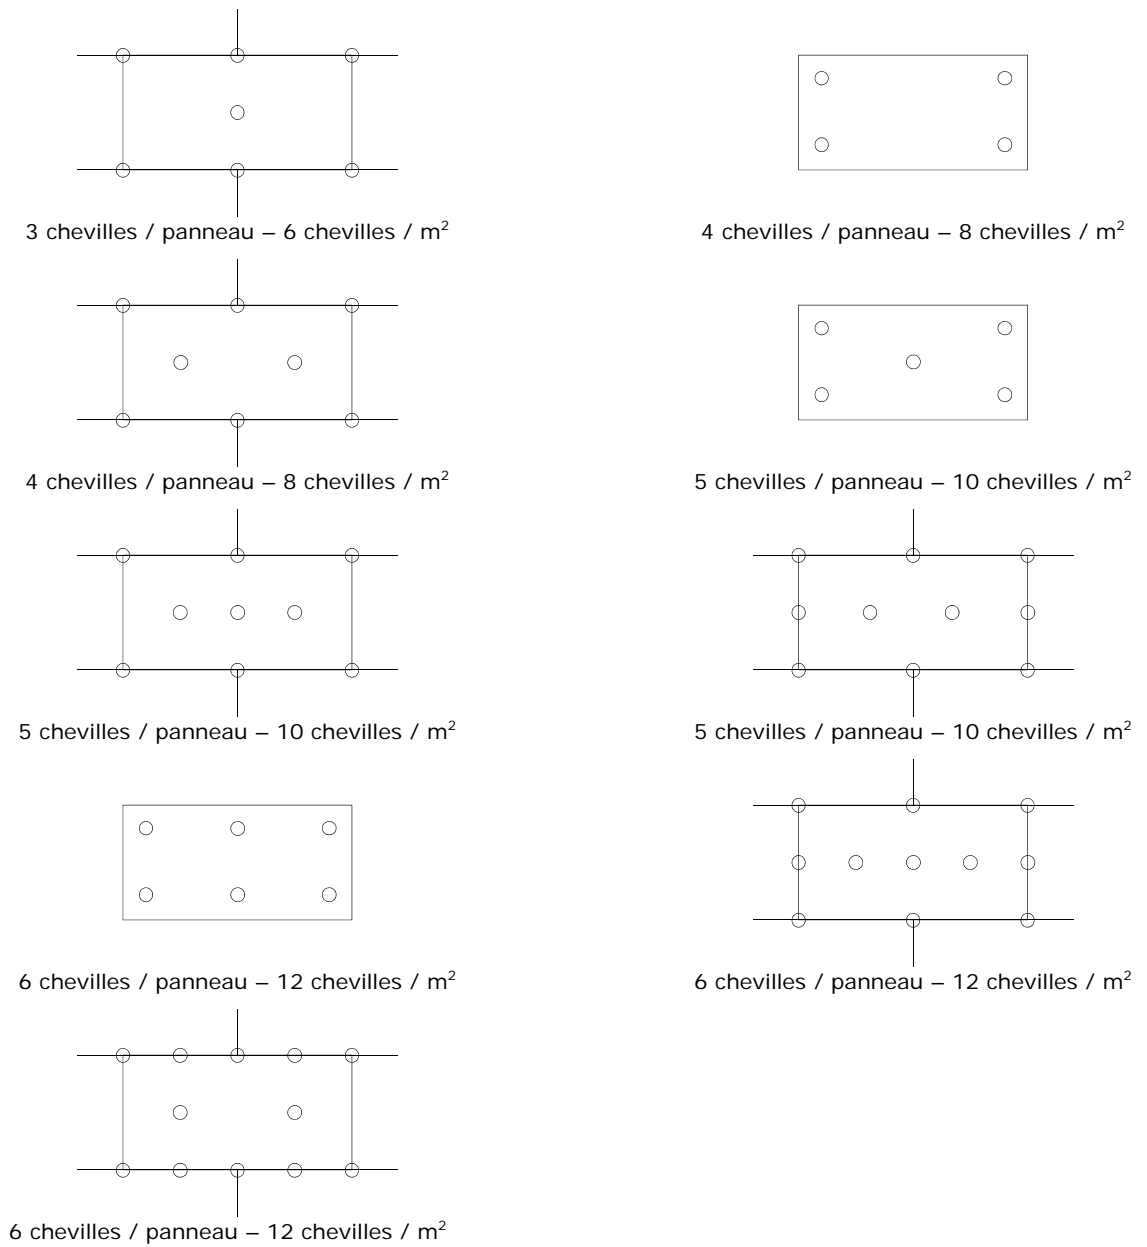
Plans de chevillage - panneaux de dimensions 1000 x 500 mm
